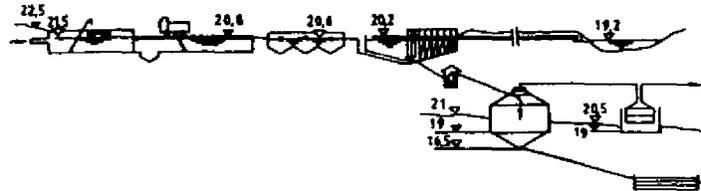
2: Sección longitudinal de una planta de tratamiento de aguas residuales
